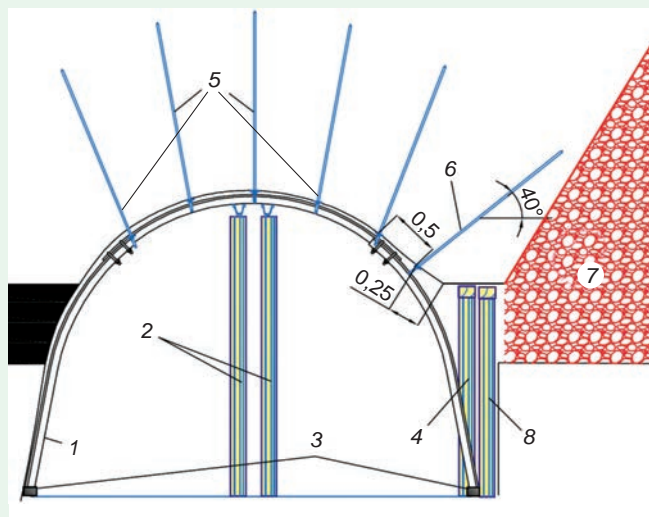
Усовершенствованный паспорт поддержания 180-го сборного штрека шахты «Самарская» за очистным забоем: 1 – арочная крепь; 2 – стойки усиления; 3 – подпятники; 4 – стойка органного ряда между кровлей пласта и подошвой выработки по бровке лавы, устанавливаемая между арками крепи; 5 – штанговые анкеры в кровле выработки; 6 – анкер для усиления кровли по бровке лавы; 7 – зона обрушения пород за очистным забоем; 8 – стойка органного ряда между кровлей пласта и подошвой выработки по бровке лавы, устанавливаемая за стойкой арочной крепи.
